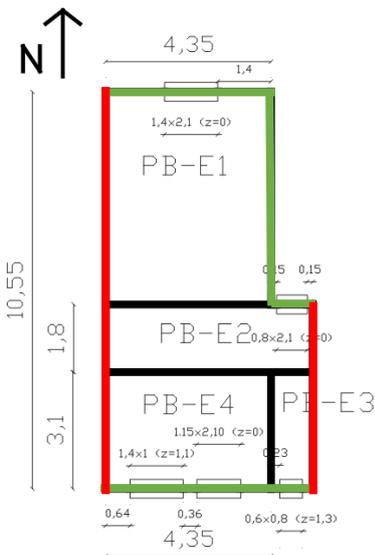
Plano del Ejemplo 0 (Obtenido de la planta baja del Ejemplo 1 del LIDER 2006)
